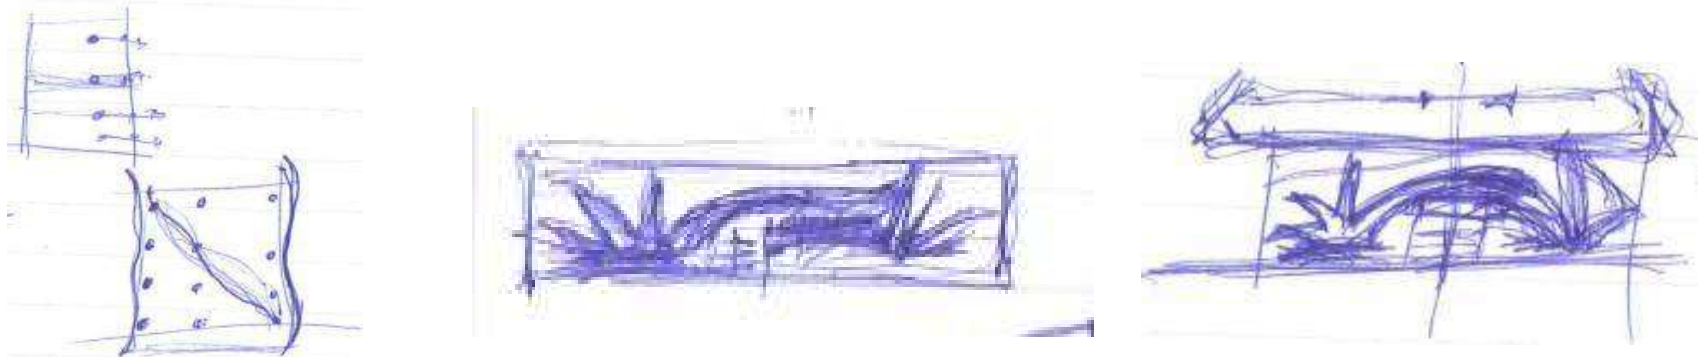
bocetos de Planta y Alzados de la Central de Autobuses
